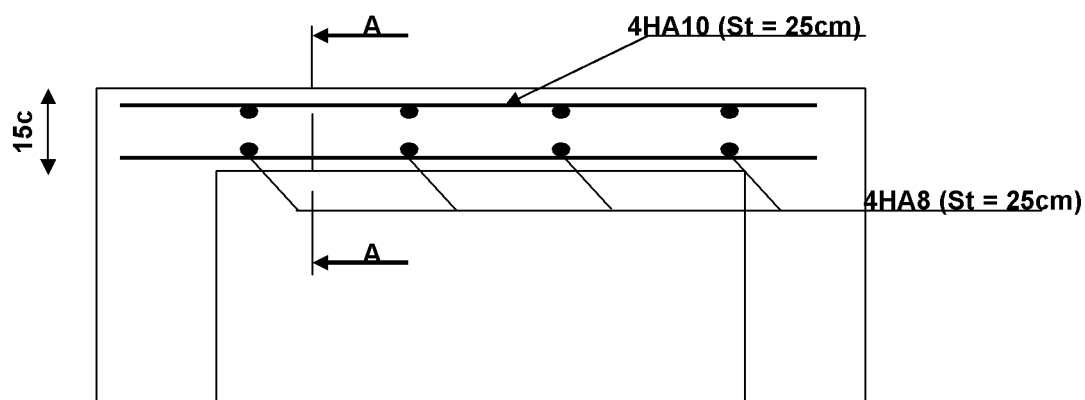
Plan de ferrailage de la dalle de la salle machine
